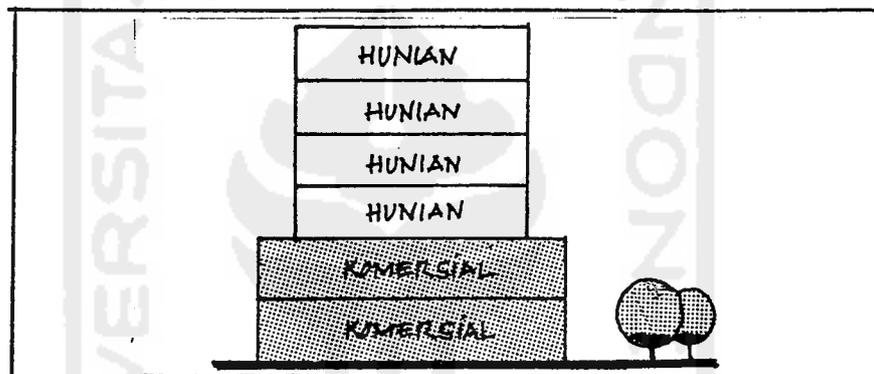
PERTOKOAN DI SEPANJANG JALAN KAWASAN LOSMENAN
